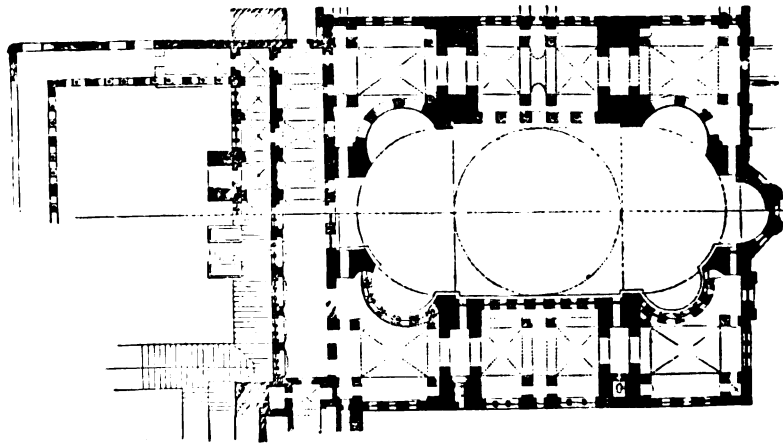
Grundriss der Sophienkirche in Constantinopel.
